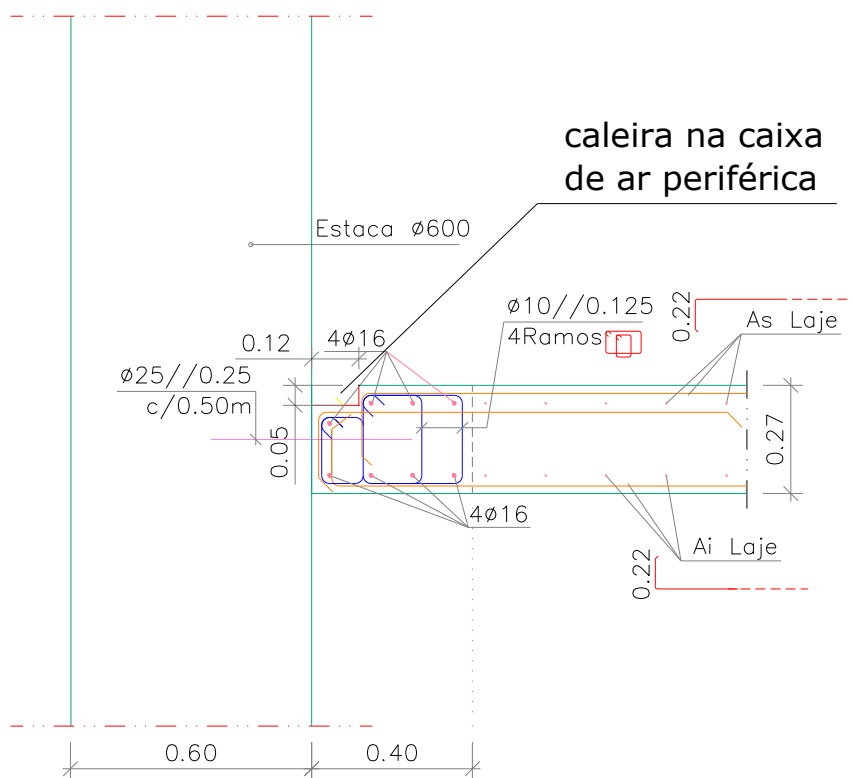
Pormenor final de ligação da laje à cortina de estacas nos pisos -1 e 0.
